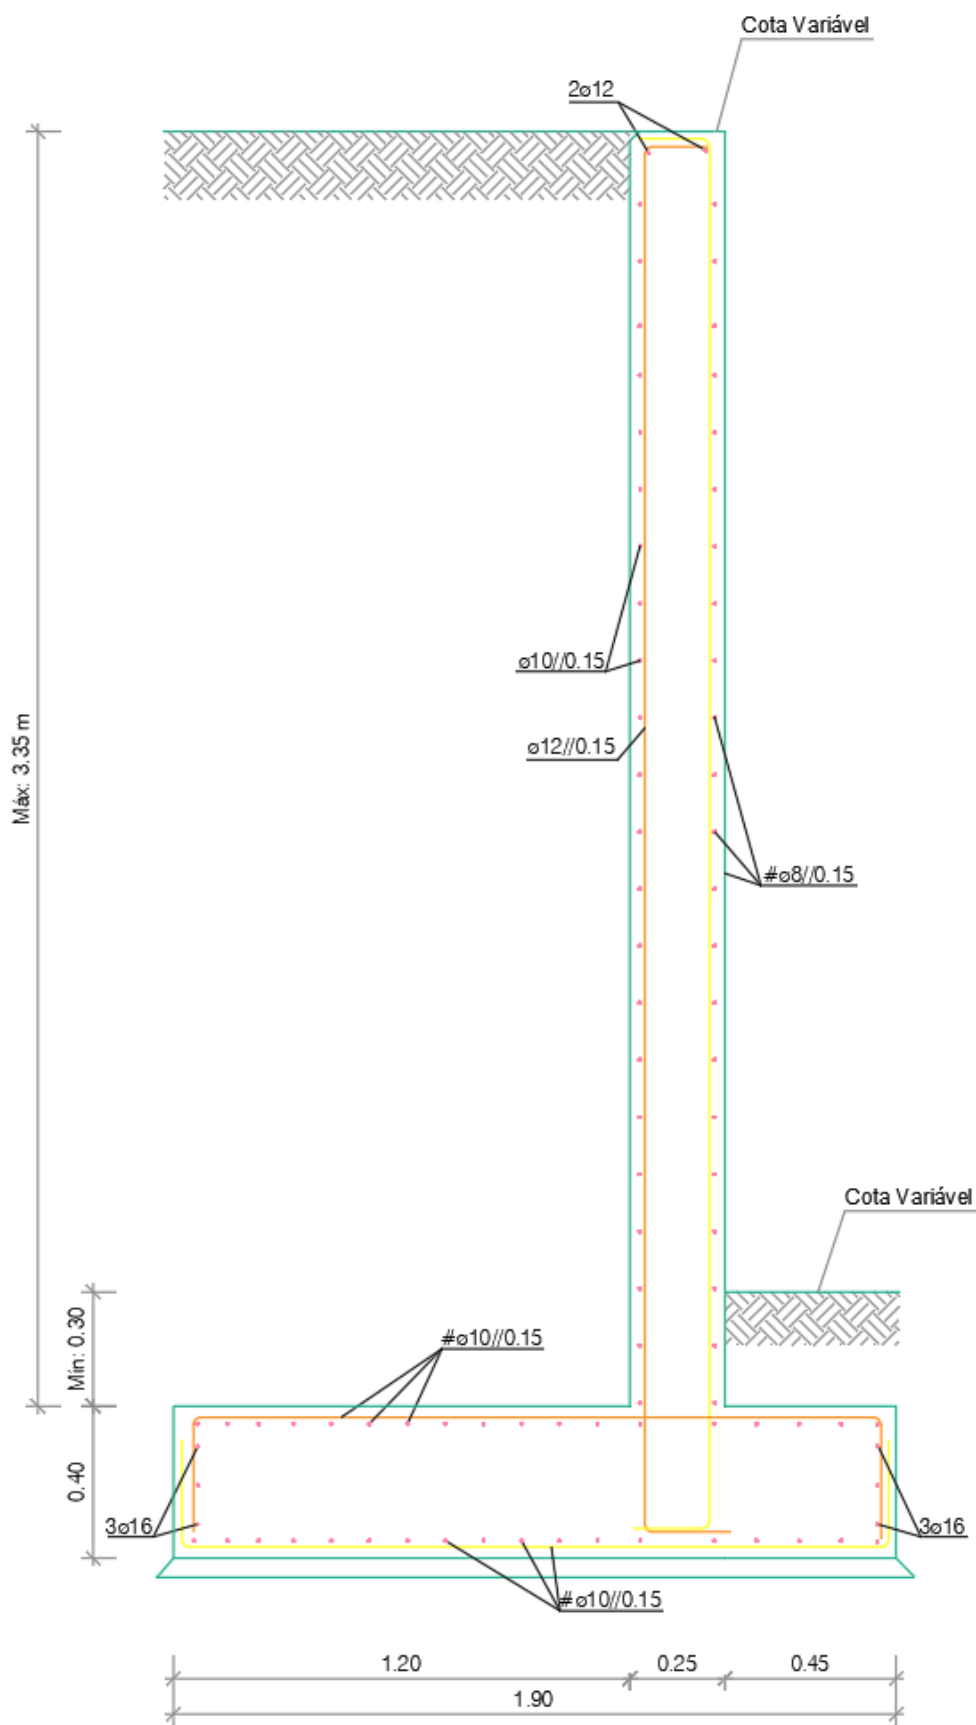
Pormenor Muro Soporte 2 (Projeto de estruturas).
